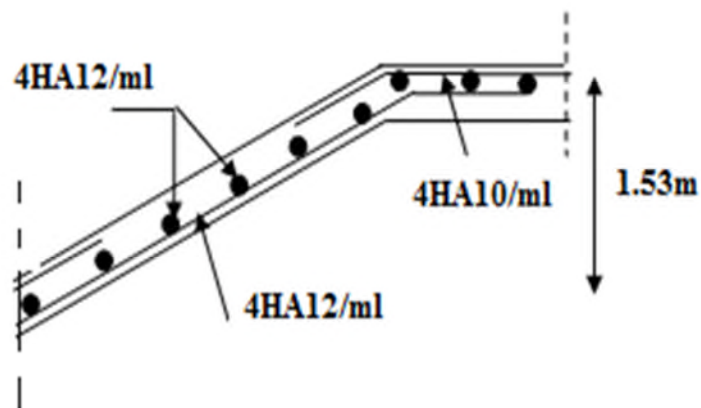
Schéma de ferrailage de volée la plus sollicitée d'escalier 1éré étage avec cage d'ascenseur
